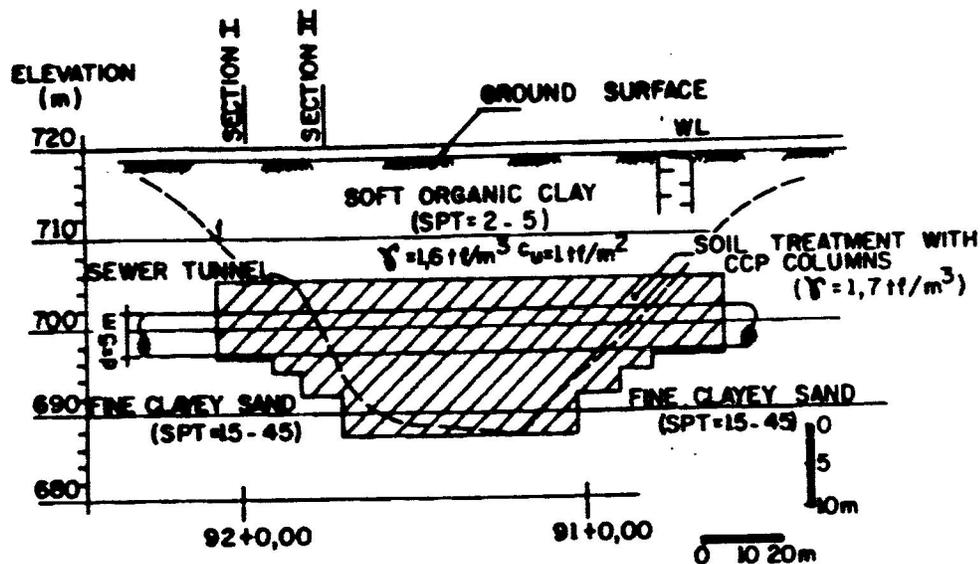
Seção Longitudinal do Túnel Tietê (São Paulo)
